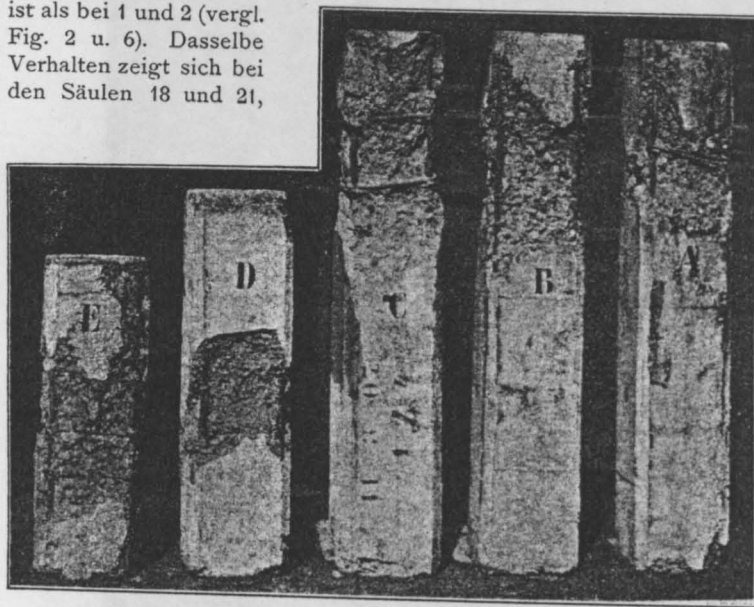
Versuche mit Eisenbetonsäulen, welche $1\frac{1}{2}$ Jahre alt sind.
